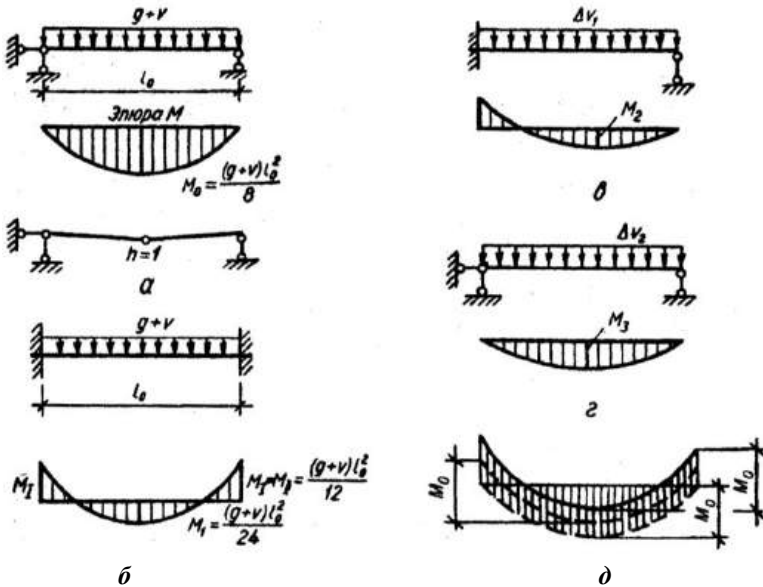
Перерозподіл моментів унаслідок появи пластичних шарнірів: а – статично визначна балка; б – статично невизначна балка; в та е – перерозподіл моментів у статично невизначній балці в разі появи пластичних шарнірів; д – можливі схеми перерозподілу моментів у опорних та прольотних перерізах
